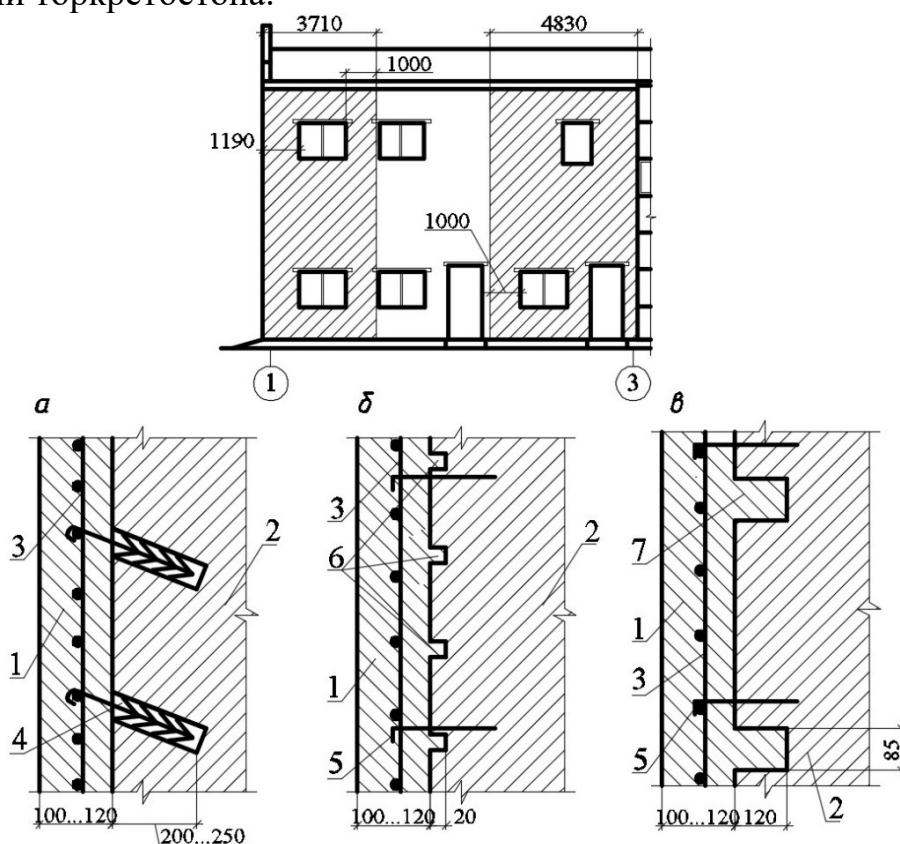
Устройство аппликаций из монолитного железобетона: а – с установкой силовых анкеров; б – с устройством борозд в горизонтальных швах кладки; в – с устройством бетонных шпонок в горизонтальных штрабах; 1 – монолитная железобетонная аппликация; 2 – усиливаемая стена; 3 – арматурная сетка; 4 – анкер, установленный в пробуренной скважине на цементном или полимерцементном растворе; 5 – анкер диаметром 12 мм из арматуры класса А240 (А-I); 6 – борозды в швах кладки глубиной 10 – 20 мм; 7 – бетонная шпонка 120×85 мм
